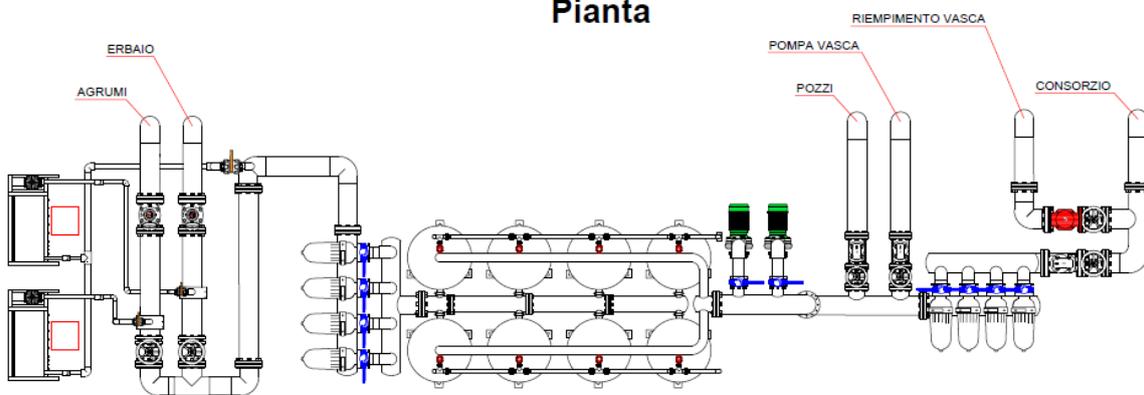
Dettaglio Impianto d'irrigazione / fertirrigazione
